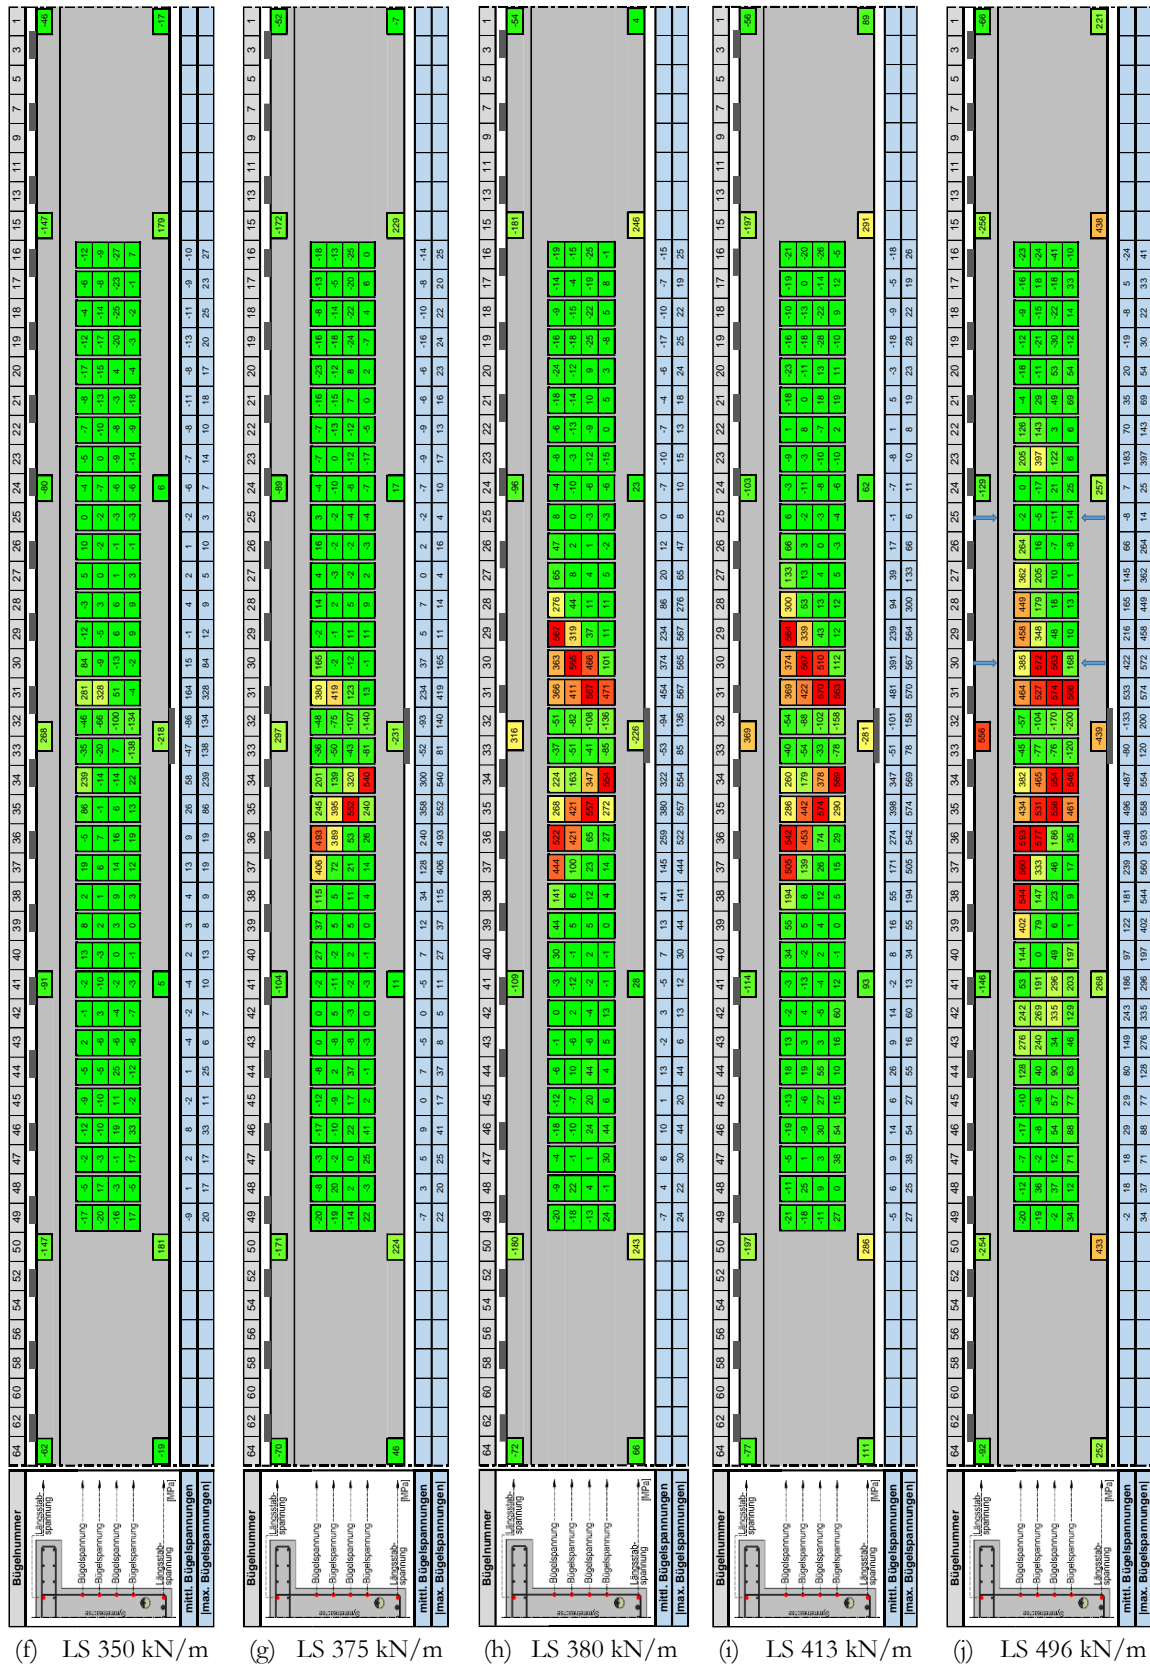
Betonstahlspannungen des Versuchsträgers DLT 4 für ausgewählte Laststufen, Teil 2
